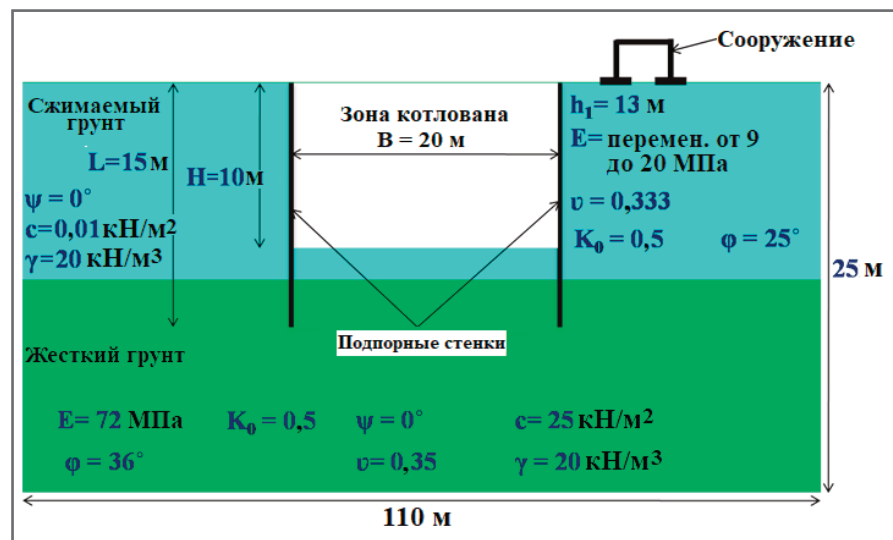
Схематический вертикальный разрез котлована и вмещающего грунтового массива
